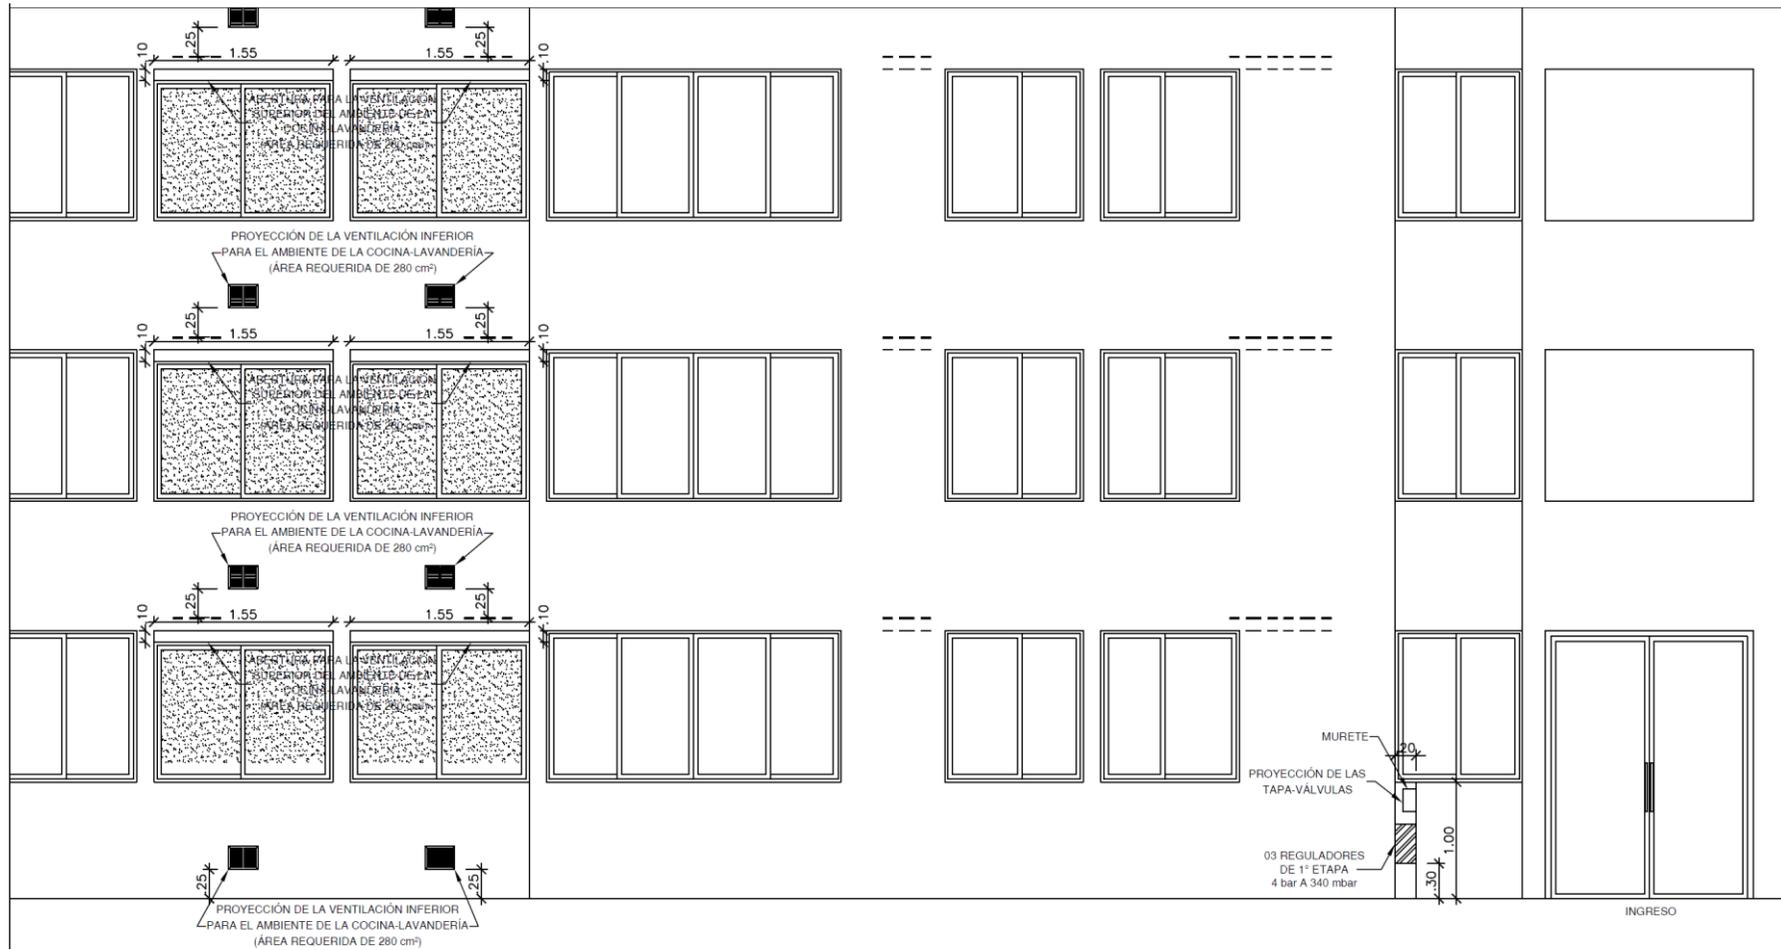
Detalle de Ventilación superior e inferior vista de fachada del edificio
